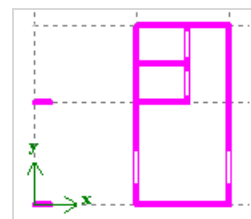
Отверстия в стенах (фрагмент плана)
